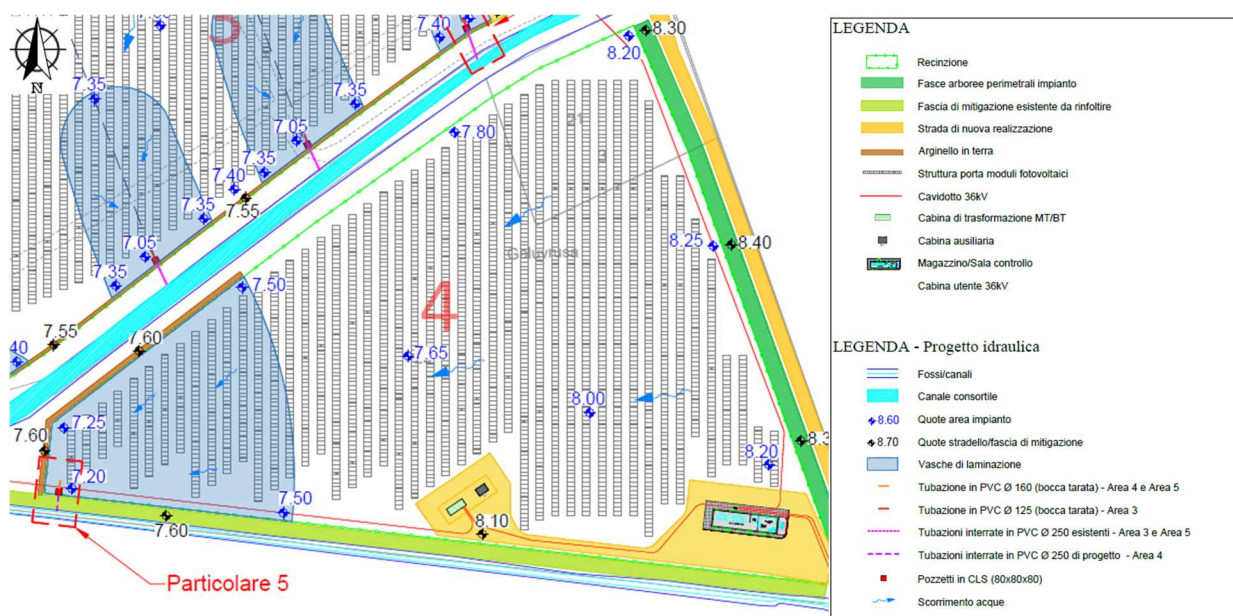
Planimetria area 4 con individuazione scarichi e vasche di laminazione (stralcio Tav. 43B)
